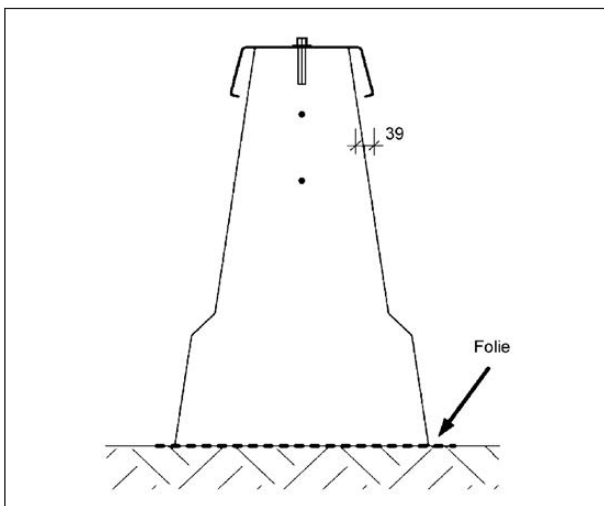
BSW O im Step 90 Profil mit 2 Ø 12 mm Bewehrung auf Folie aufgestellt; Quelle: DEKRA
